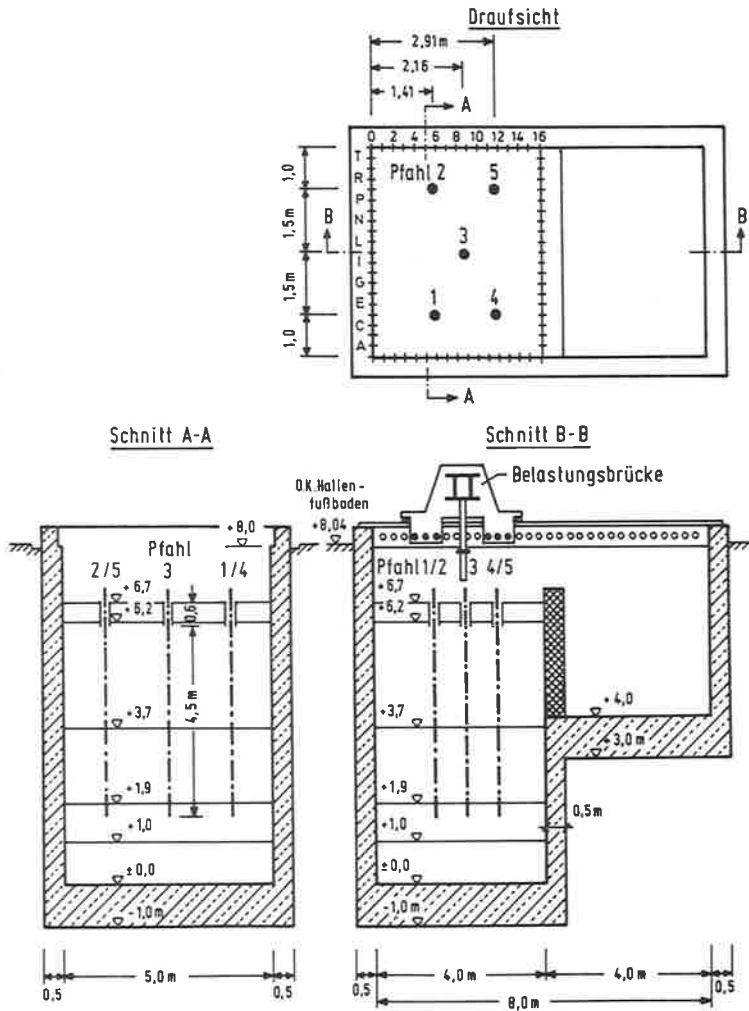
Versuchsgrube des Prüfamtes für Grundbau, Bodenmechanik
